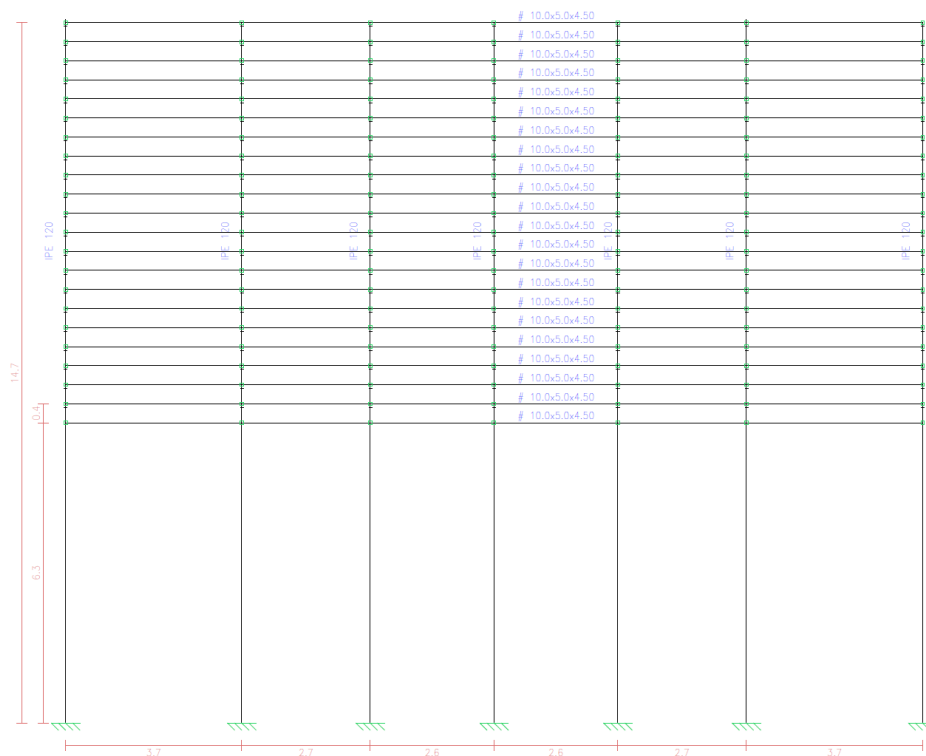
Estructura metálica portante con cotas y descripción de los perfiles
